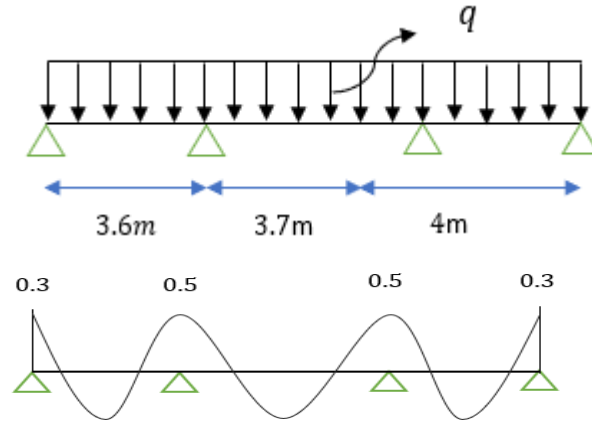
Schéma statique de la poutre appuyée sur 4 appuis.
